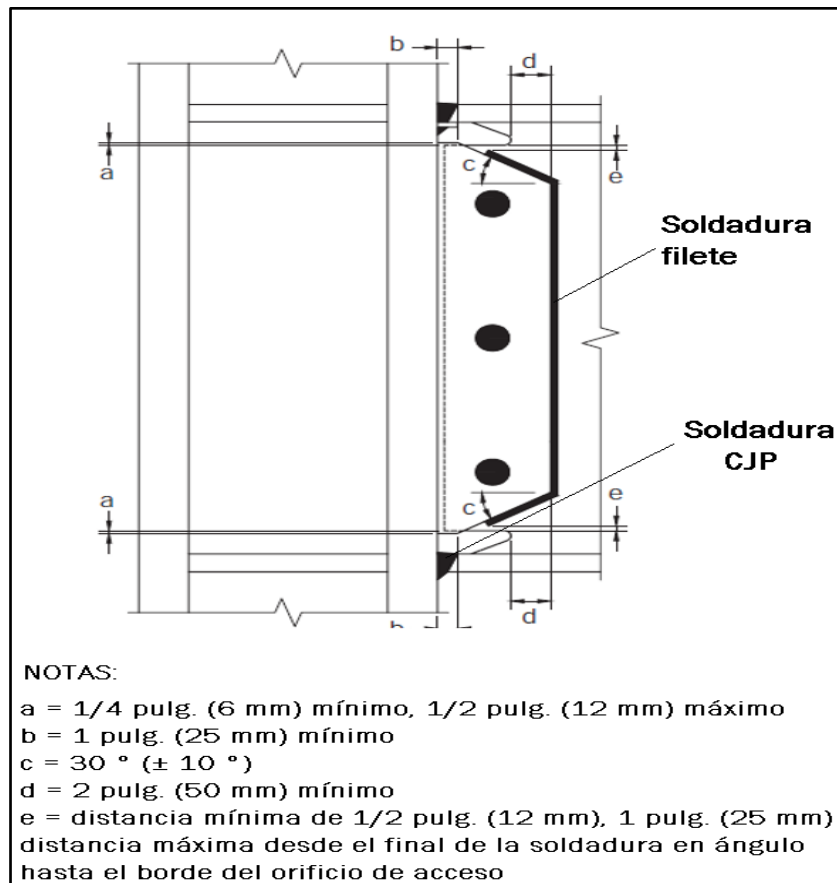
Detalles en la parte superior e inferior de la conexión de corte de placa única. AISC358 (2016)
